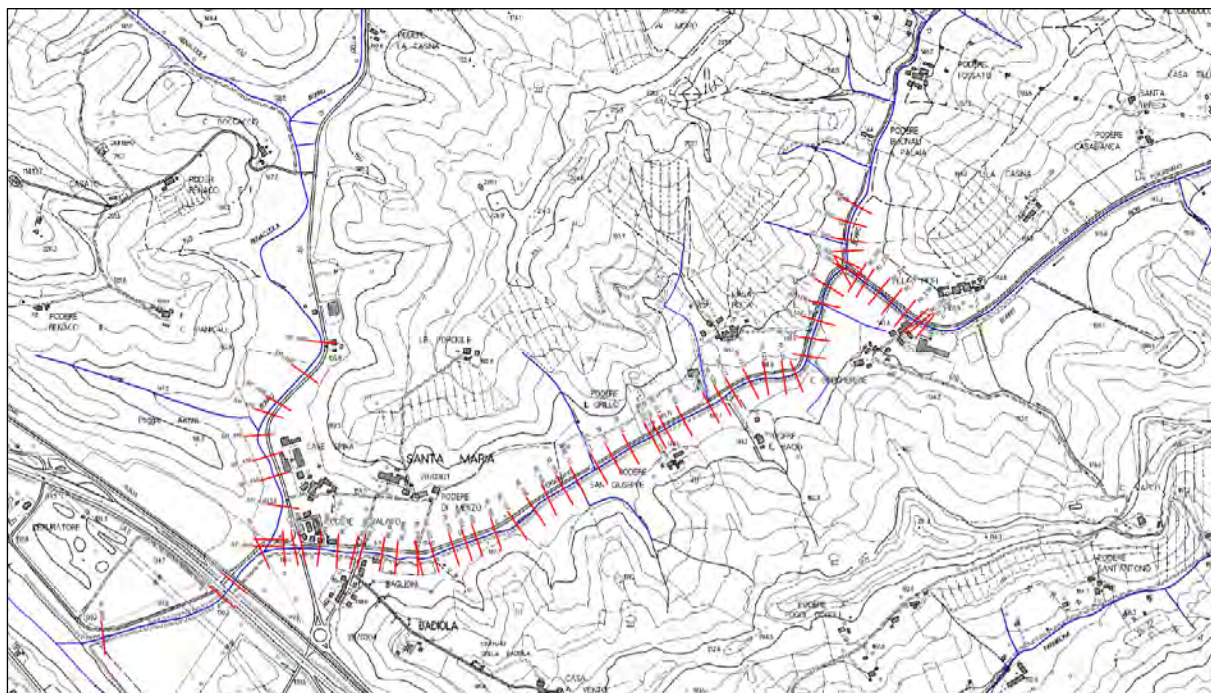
Planimetria sezioni Torrenti: Riofi, Piantravigne, Spina .
